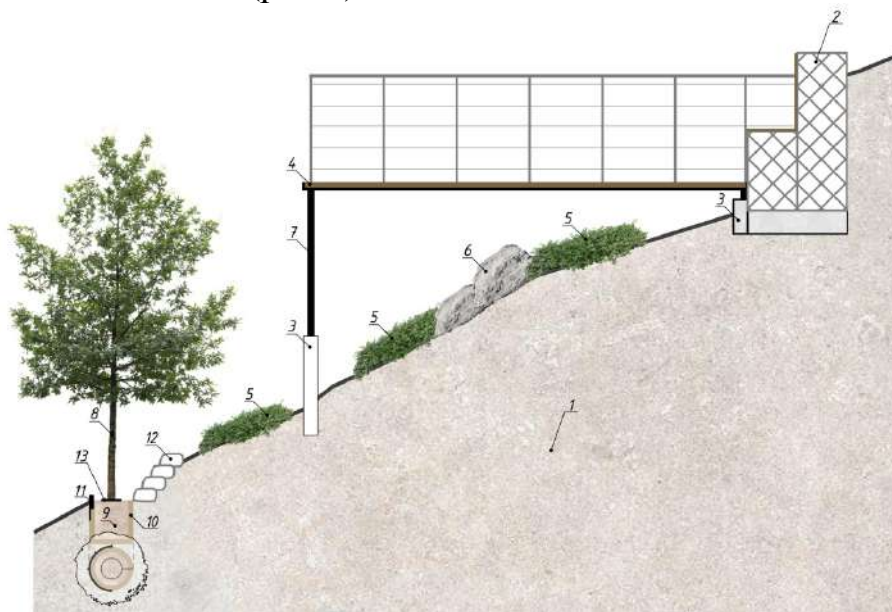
Схема организации «подвесных» площадок (троп) и схемы посадки проектируемых растений: 1 - склон; 2 - подпорная стена (габион заполненный местным камнем); 3 - армированный бетонный фундамент опор; 4 - перекрытие площадок и дорожек (металлокаркас + ДПК); 5 - сохраняемые заросли иглицы; 6 - каменные глыбы (существующие); 7 - металлические опоры; 8 - проектируемы растения; 9 - земляной ком; 10 - отсыпка плодородным грунтом; 11 - металлический «бордюр»; 12 - камни; 13 - элементы системы полива
